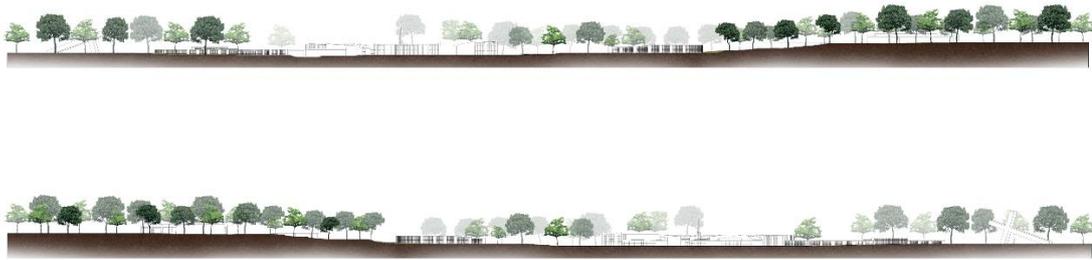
Fachadas de la propuesta de Eco-cementerio. Elaboración: Tesista
